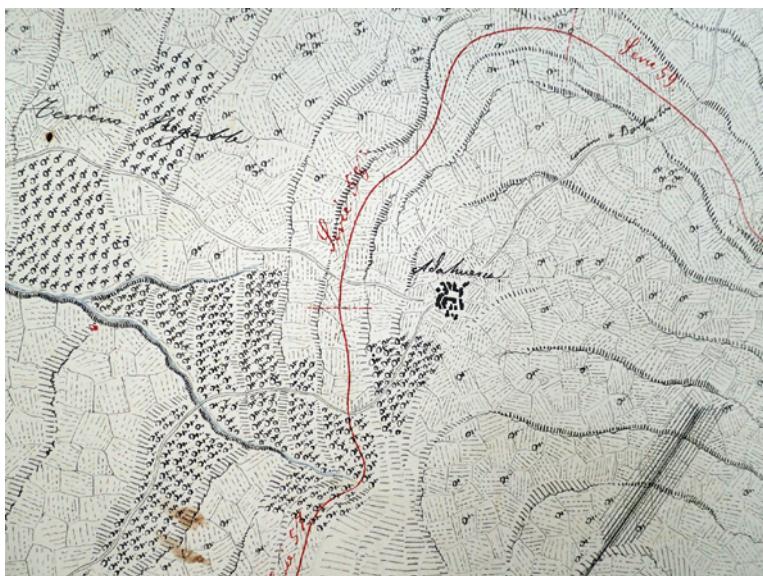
Planta del canal en Adahuesca, con detalle de olivares.
